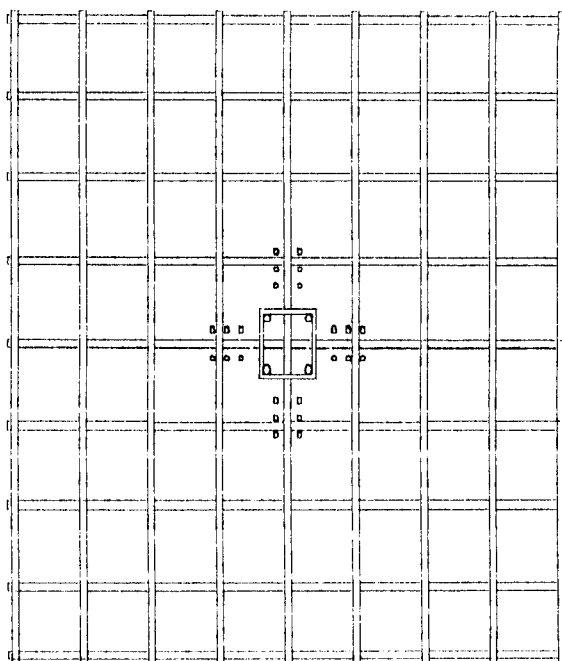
Distribuição da Armadura Longitudinal Tracionada do Modelo.
